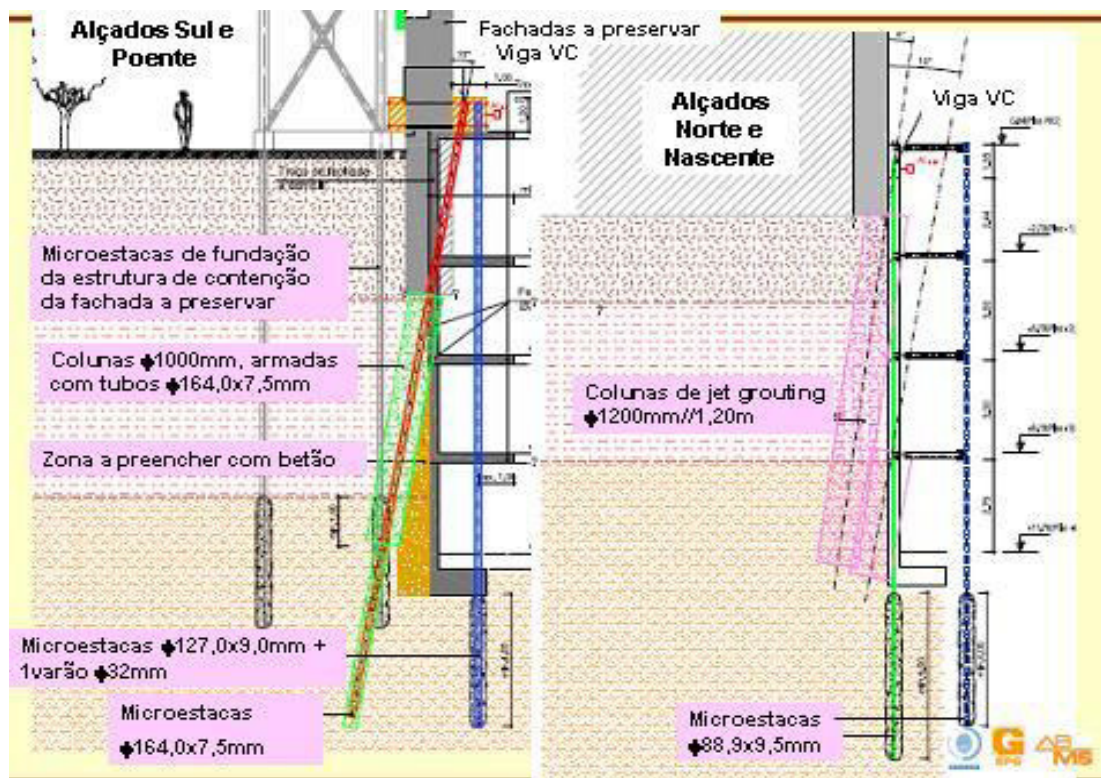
Corte transversal das soluções adotadas (Pinto et al, 2008)
